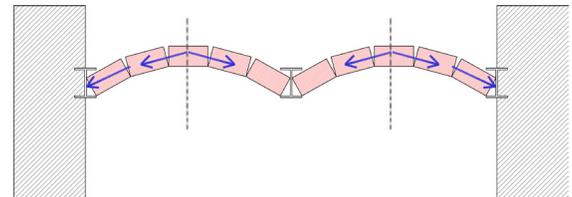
Esquema transmisión de cargas de bovedillas a muros. Elaboración propia
